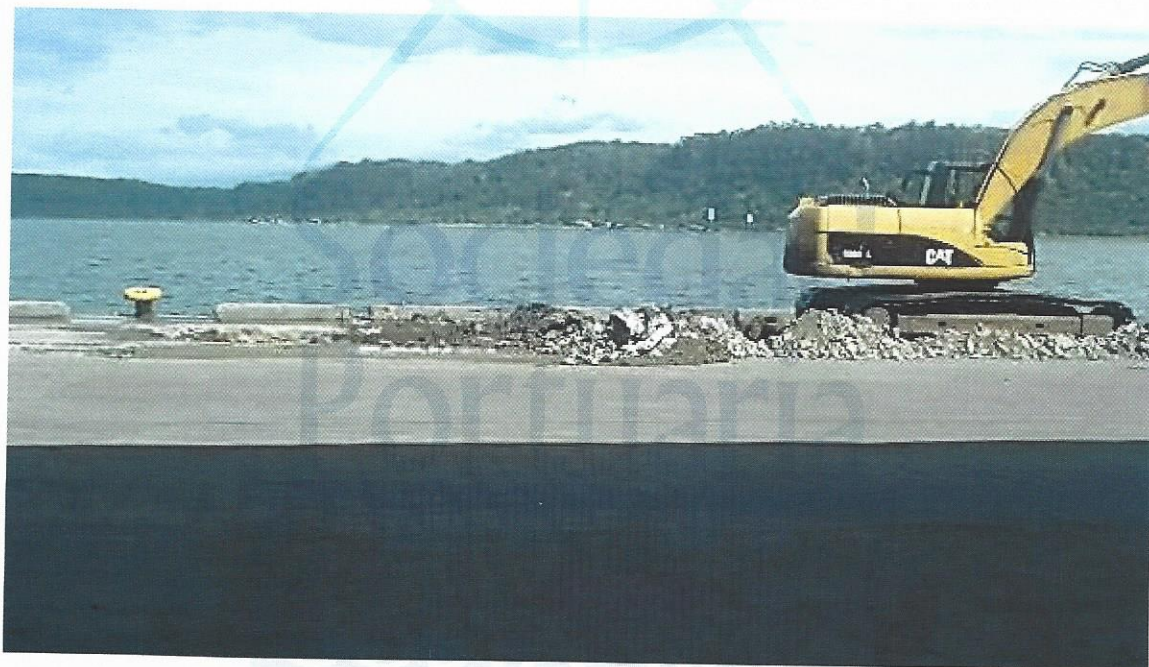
Gaveta de reparación pavimento de adoquines puesto dos
